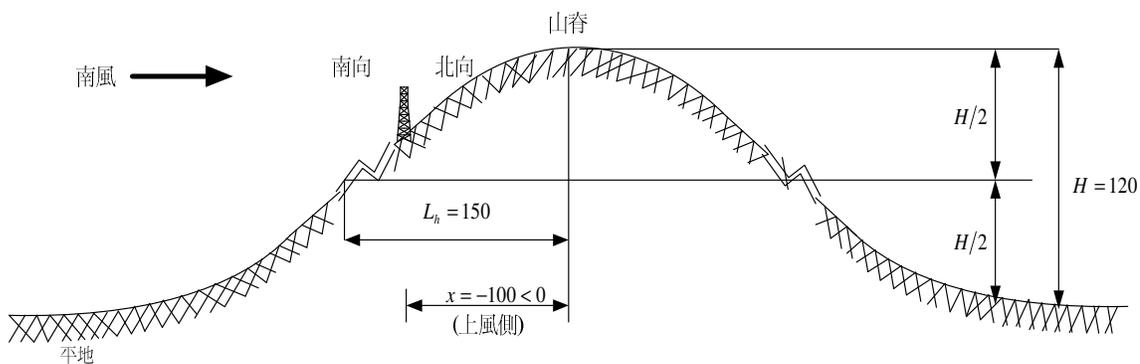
獨立鐵塔東向與附近地形的立面示意圖 單位 (m)
